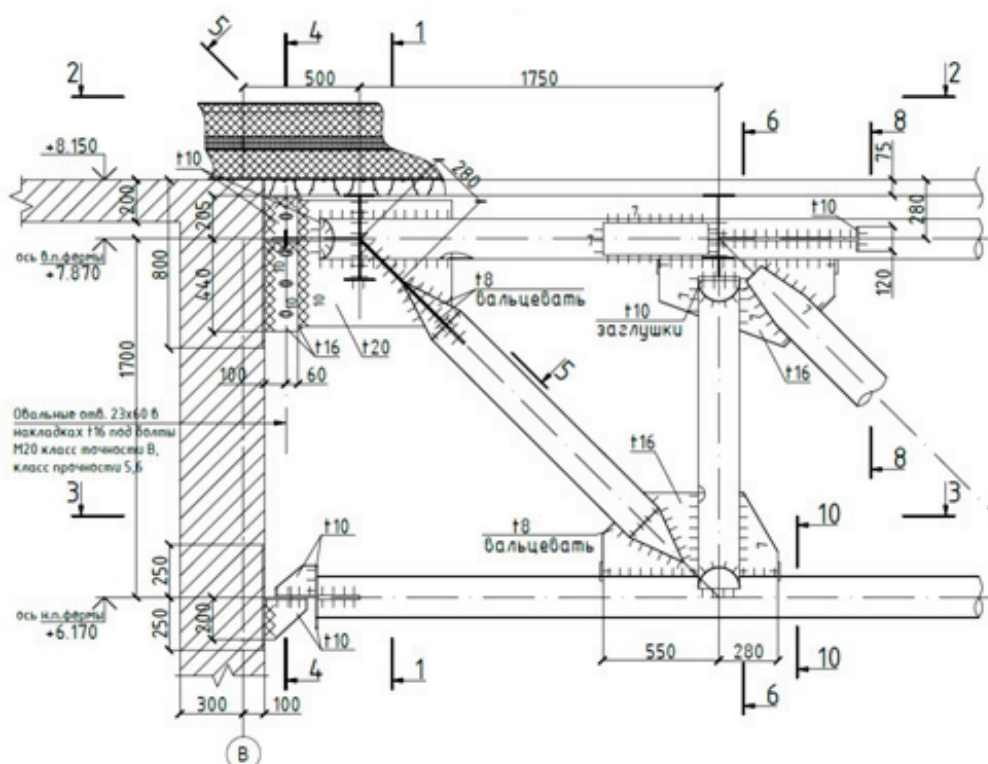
Узел примыкания пространственной фермы к железобетонной стене и балке. Автор – Н.Р. Проничкин
